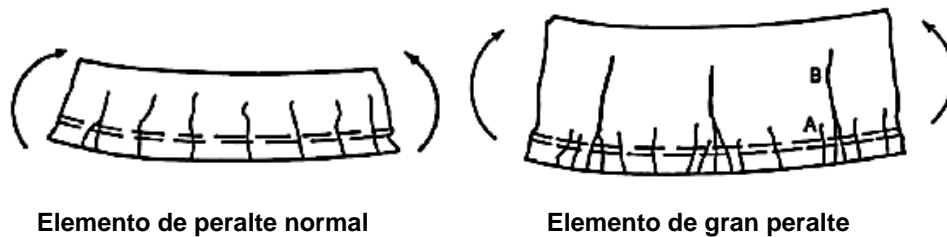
Grietas por esfuerzos de Tracción por Flexión
